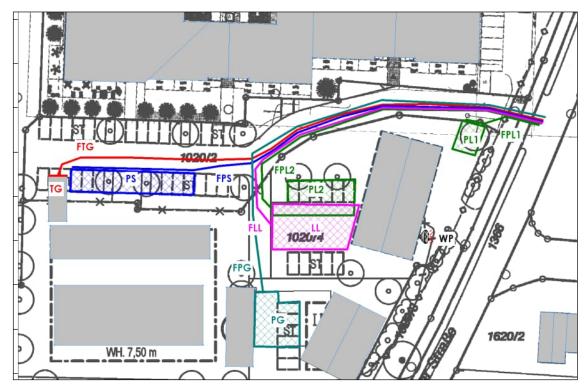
Lageplan mit Darstellung der relevanten Schallquellen - Anlagenbedingter Lärm
